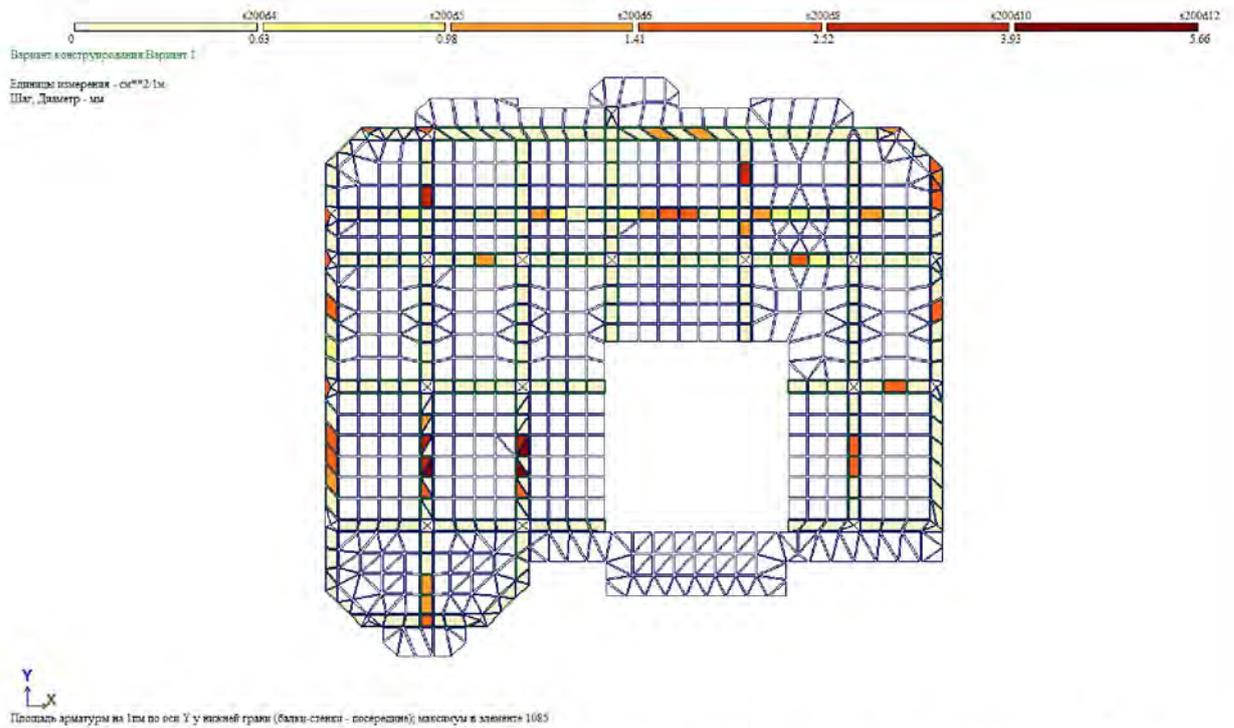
Площадь армирования по оси Y у нижней грани в ребрах.
